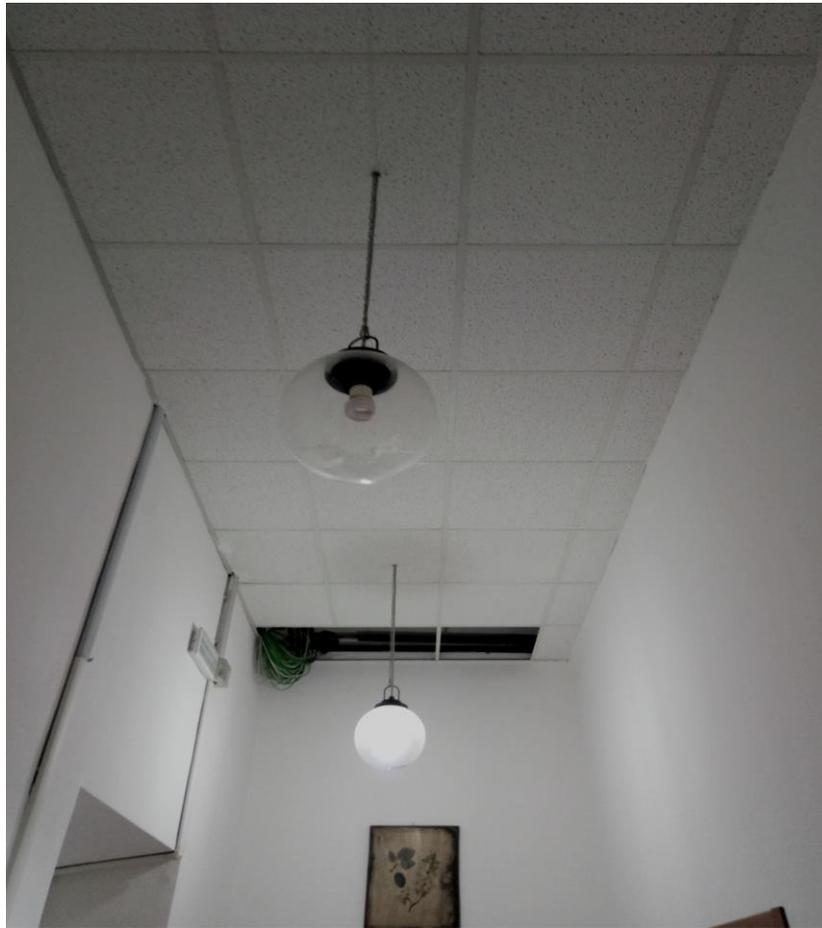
Corpi illuminanti utilizzati nei corridoi della zona 3
